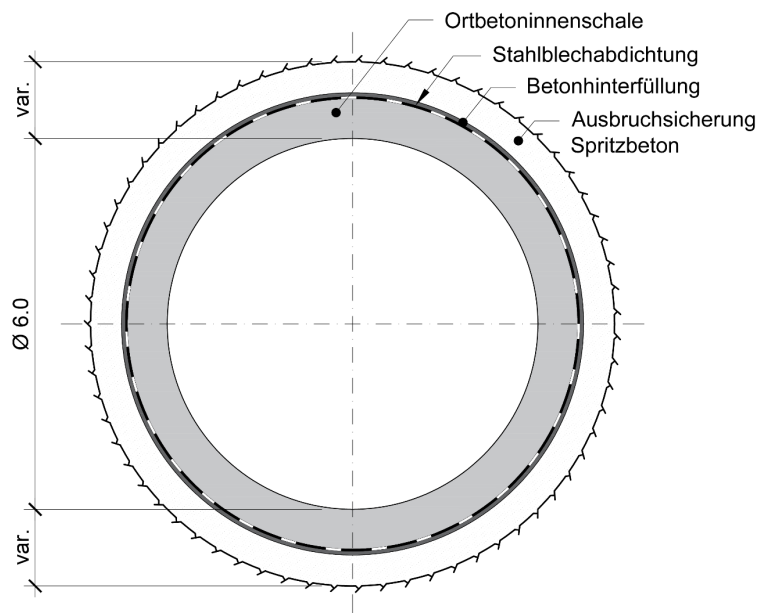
Beispielhaftes Normalprofil Lüftungsschacht
